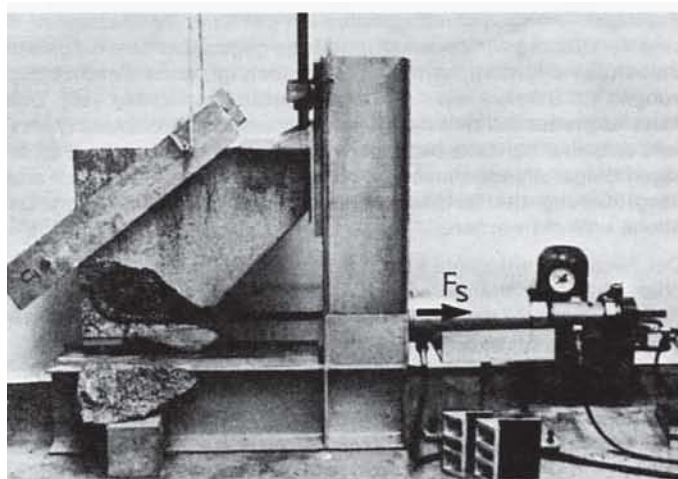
Betonabplatzungen im Bereich der Hakenkrümmung (nach [16])
